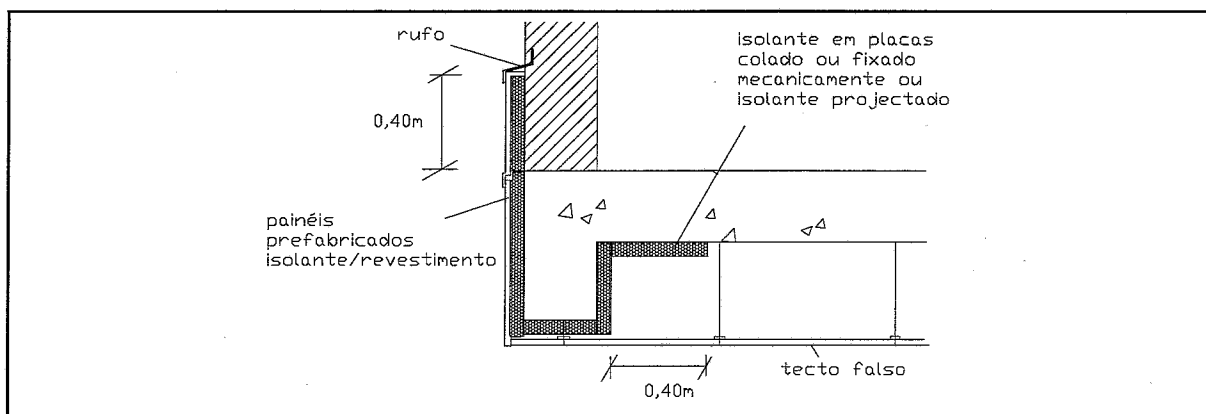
Pormenor da correcção térmica com placas prefabricadas isolante/revestimento e isolante fixado à laje com disfarce com tecto falso
